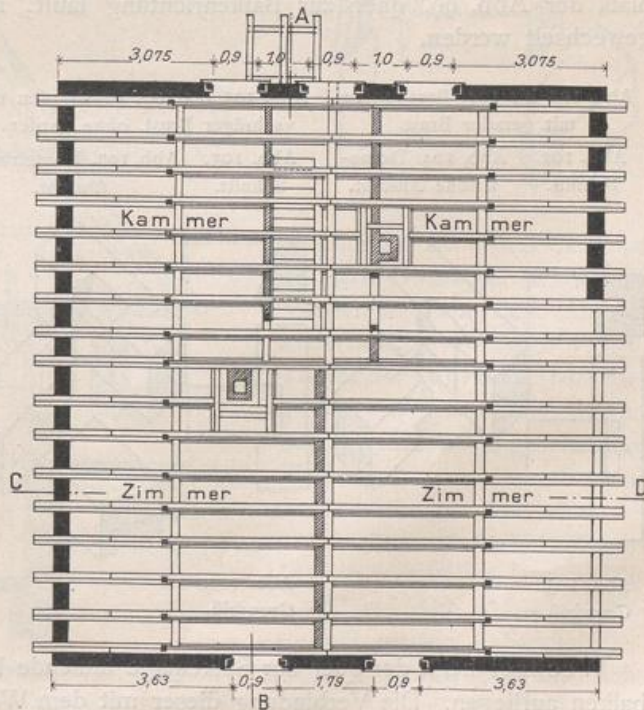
Werkplan des Dachgeschosses. M. 1 : 150.
